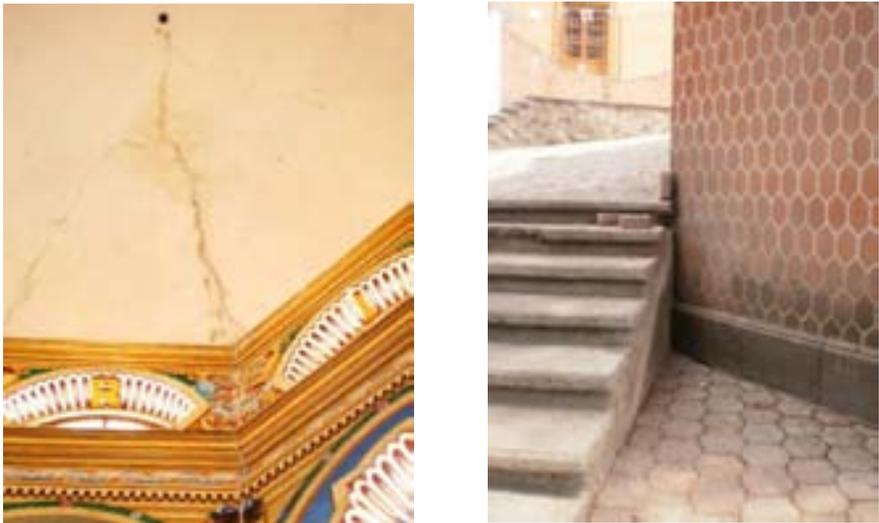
Grietas y fisuras en muro y cúpula, presencia de humedad.
